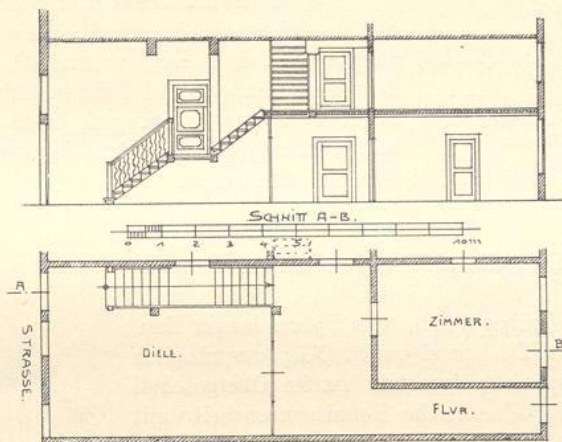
Burgstraße 7. Diele. Grundriß und Schnitt.
